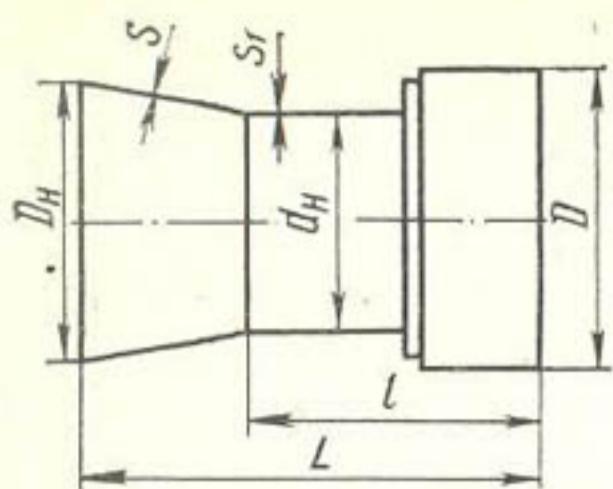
Переходы для соединения стальных и железобетонных труб.
